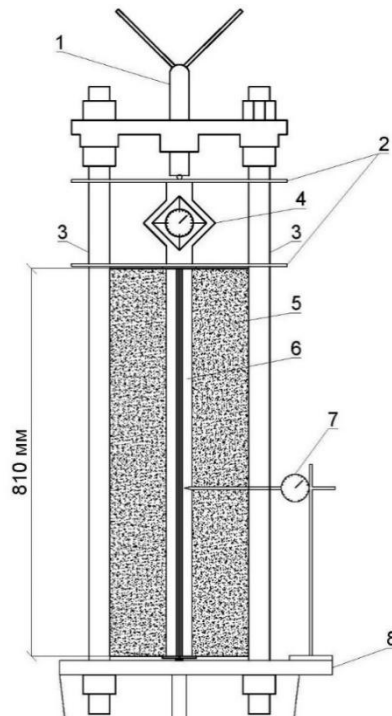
Схема испытания стойки, находящейся в пенобетонной обойме:
